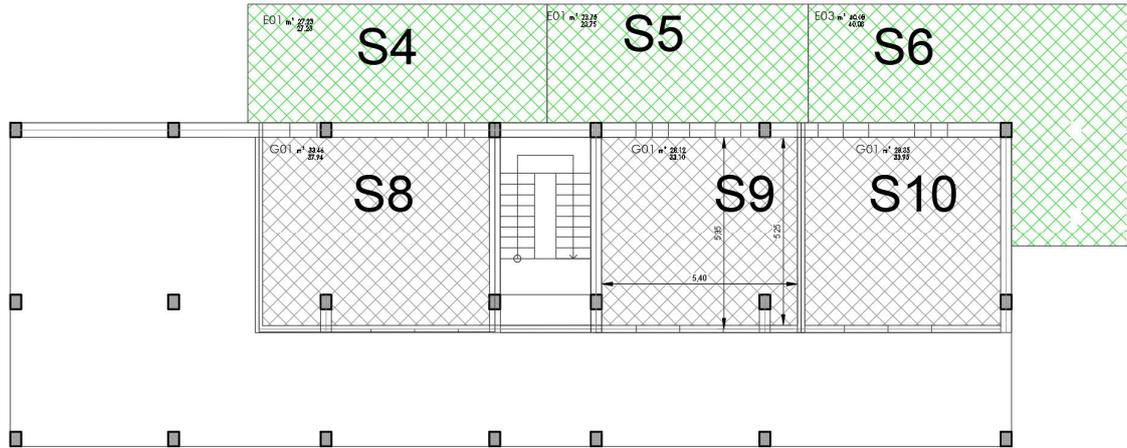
Abitazione. Pianta piano terra sub 4 e 8
